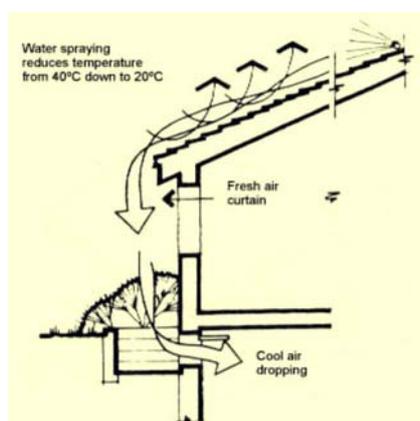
Exemplo de um sistema “roof spraying” (Adaptado de Lanham; Gama; Braz, 2004).
